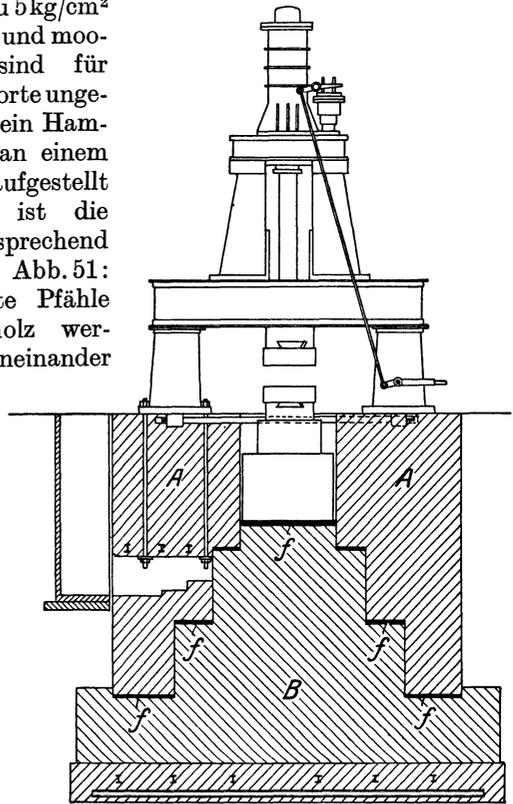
Dampfhammerfundamentierung (nach Schweißguth).
